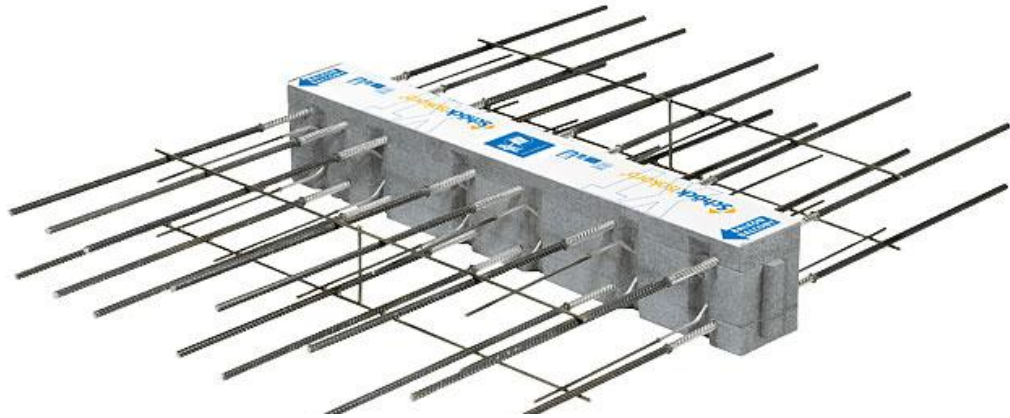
Schöck Isokorb KXT-WU -lämmöneriste-elementti. [1.]
